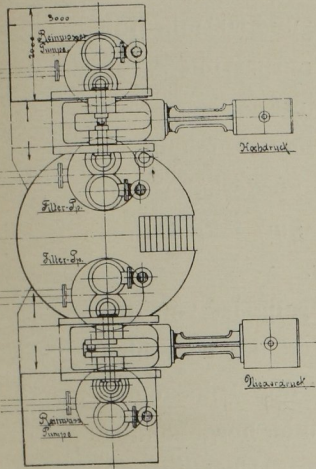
Grundriss der Gesamtanlage. Massst. 1 : 150.
